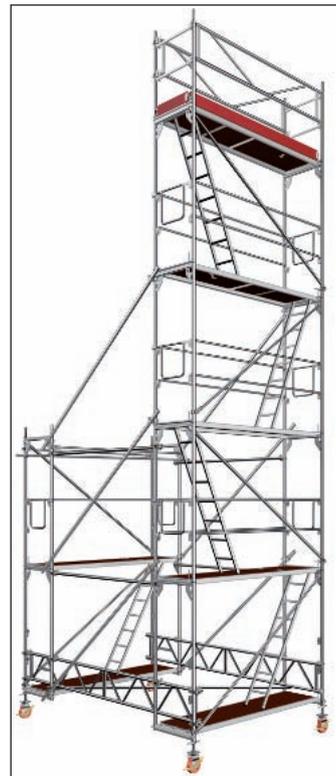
Две секции строительных лесов соединяются фермами, трубами и хомутами.
